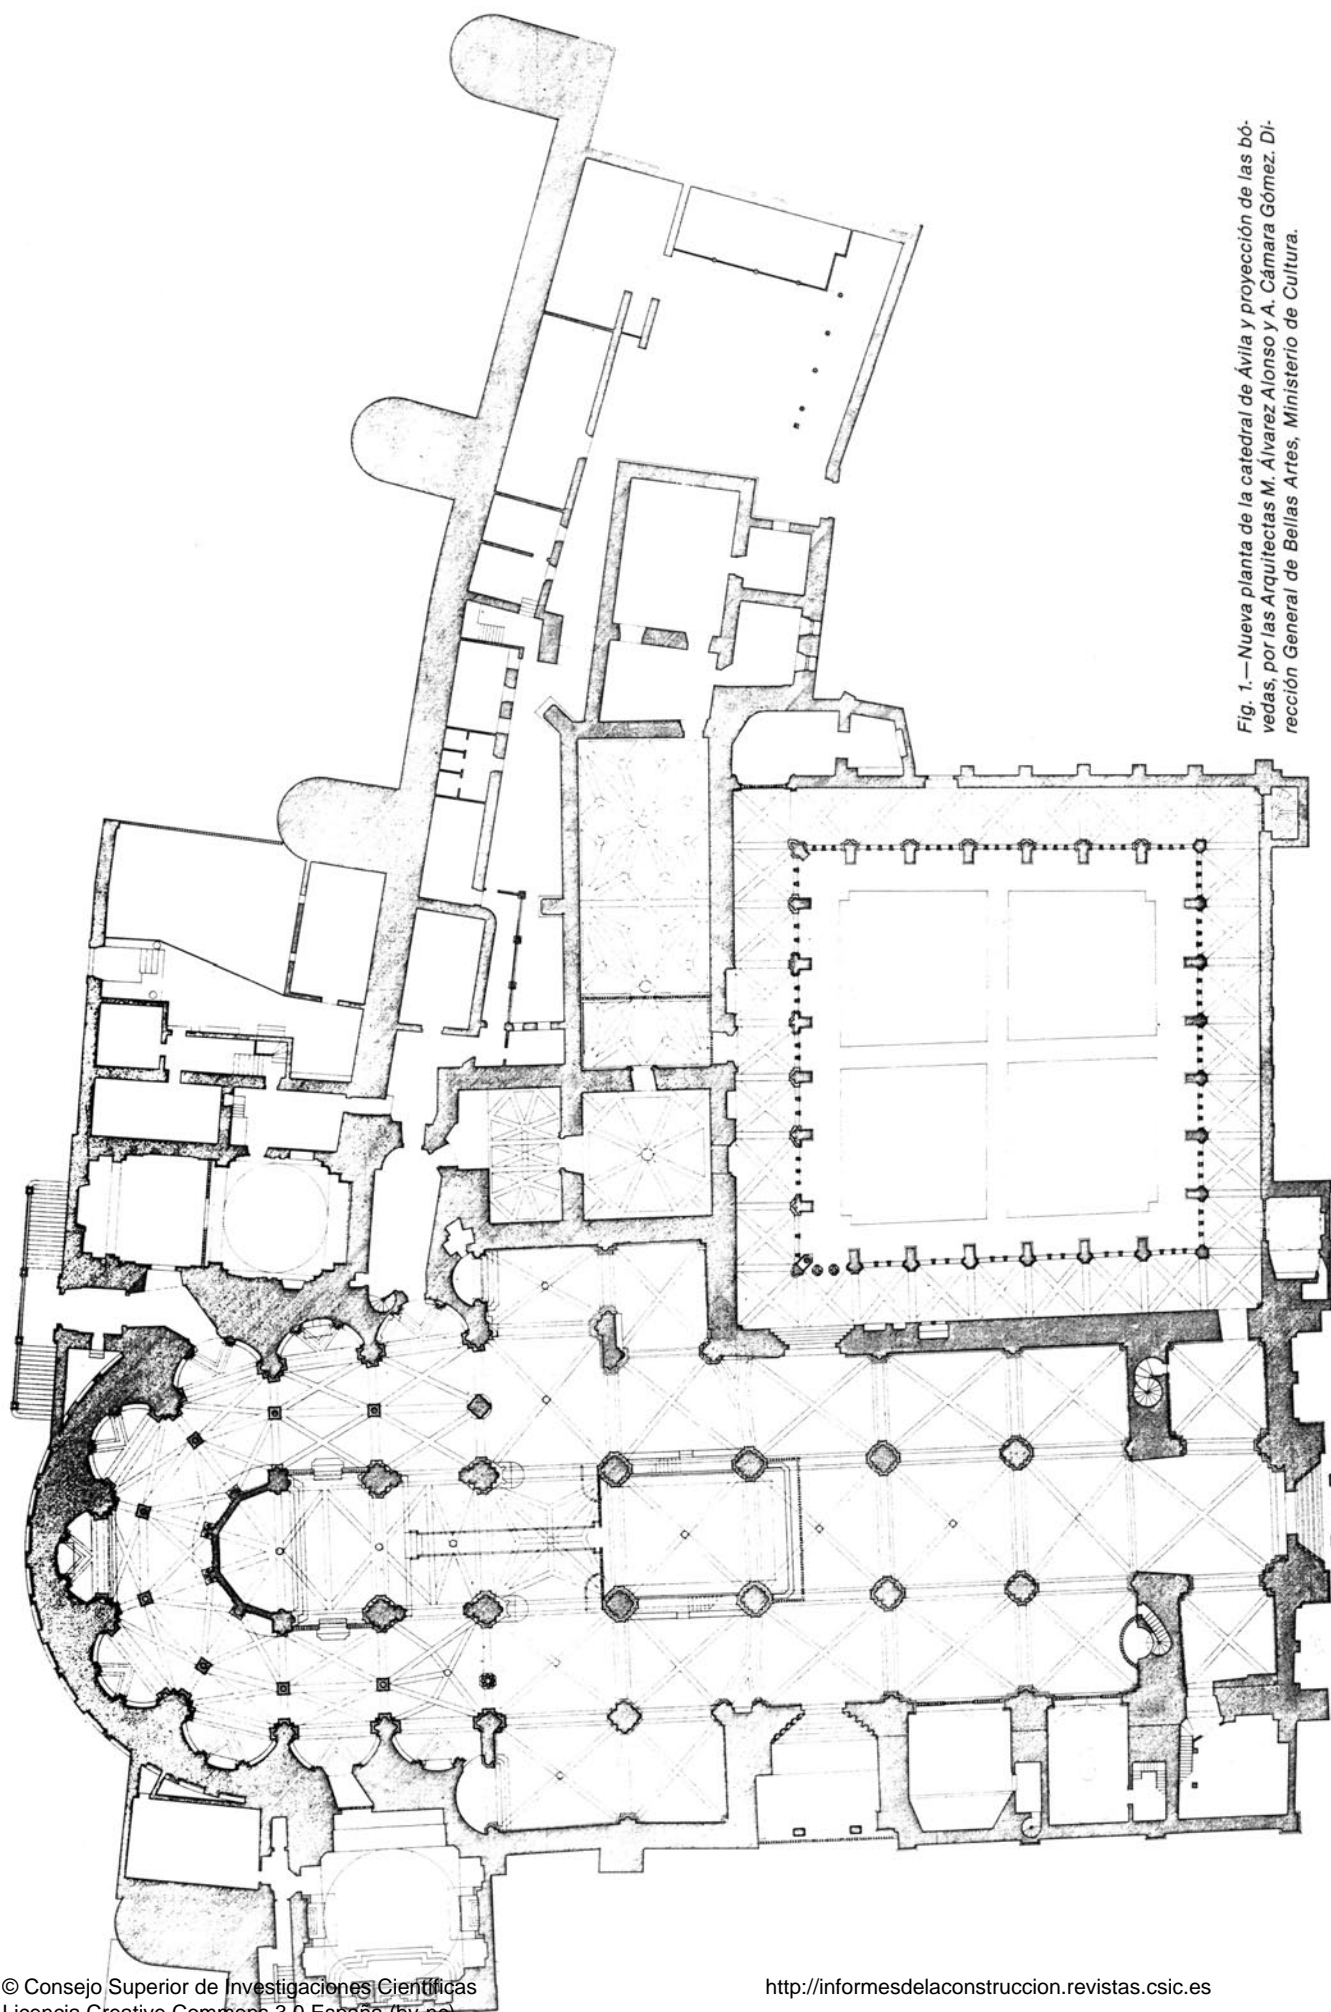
Nueva planta de la catedral de Ávila y proyección de las bóvedas, por las Arquitectas M. Álvarez Alonso y A. Cámara Gómez. Dirección General de Bellas Artes, Ministerio de Cultura.
